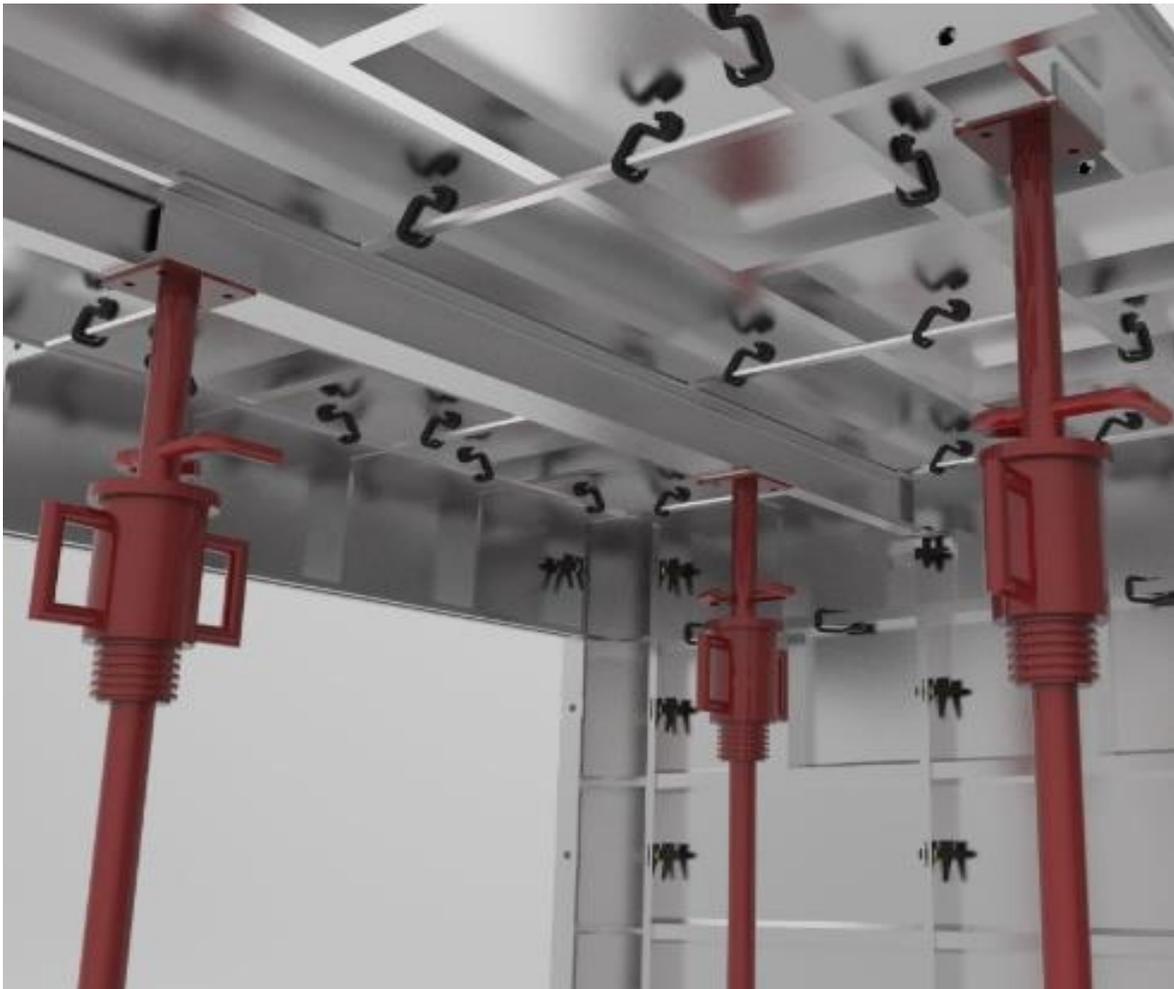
Render de paneles de losa y paneles de losa con puntal
